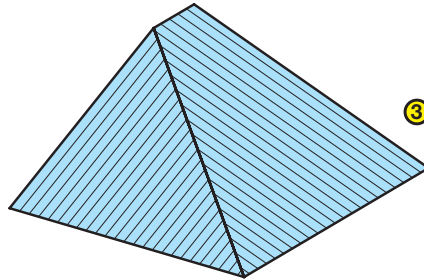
Dachausmittlung – ohne Maßstab – der beiden an der Konstruktion „beteiligten“ Dachkörper. Der oben dargestellte steiler geneigte Dachkörper ist der „Hauptdachkörper“, der flacher geneigte ist der „Aufschieblingsdachkörper“. Beide Dachausmittlungen werden hier unabhängig voneinander bezogen auf die jeweiligen Profile ausgeführt.
